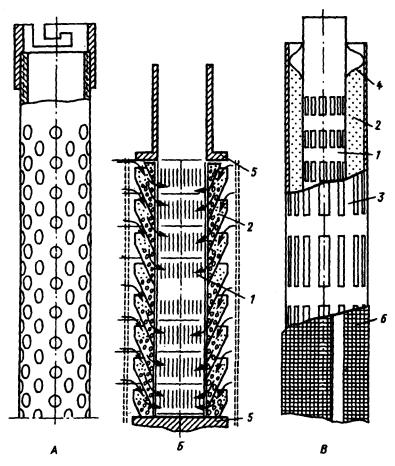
Фильтры: трубчатый стальной (A); корзиночный (Б); кожуховый (В).
